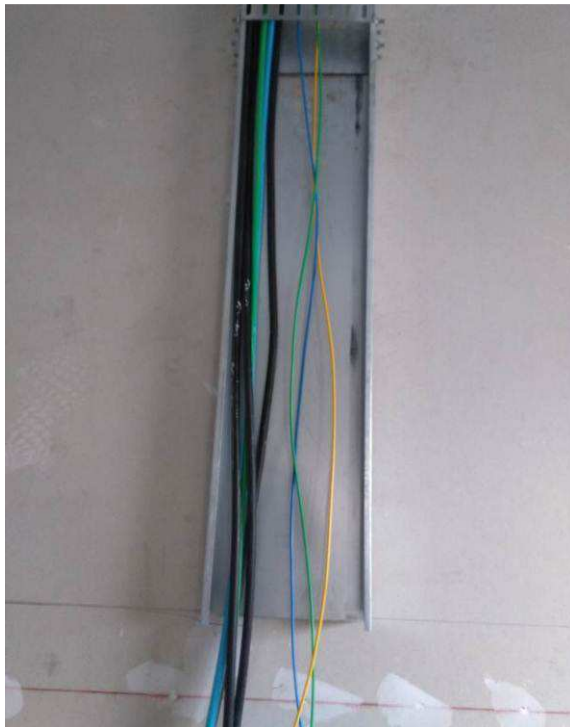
E: ramal alimentador e cabeamento elétrica comum 1º pavimento
